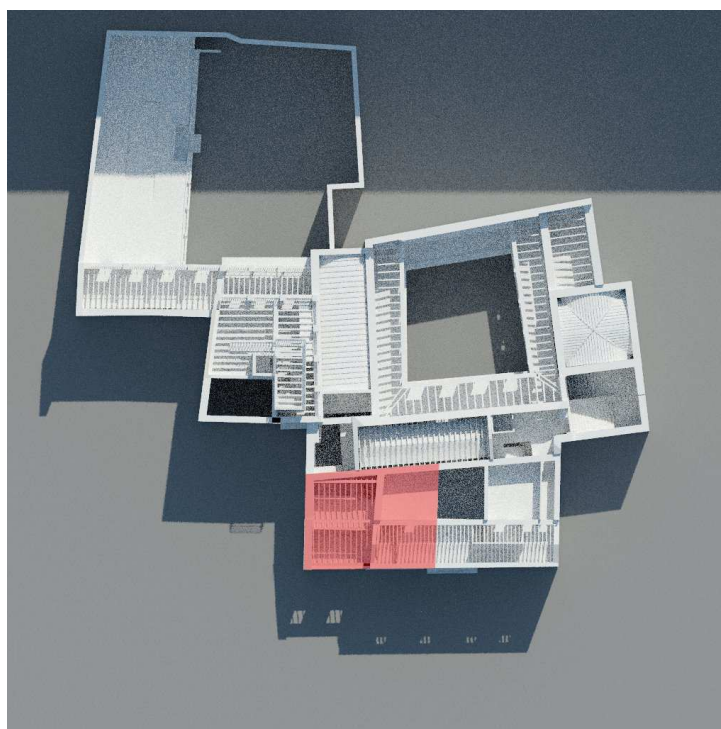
Emplazamiento de la intervención en el inmueble
